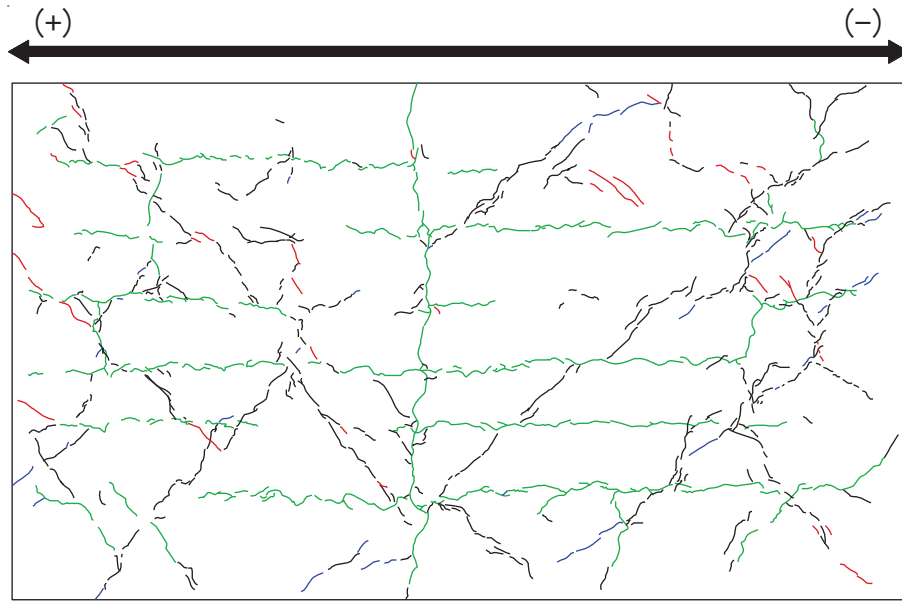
(7) 乾燥試験体 [1] 1/1250rad. におけるひび割れ図
